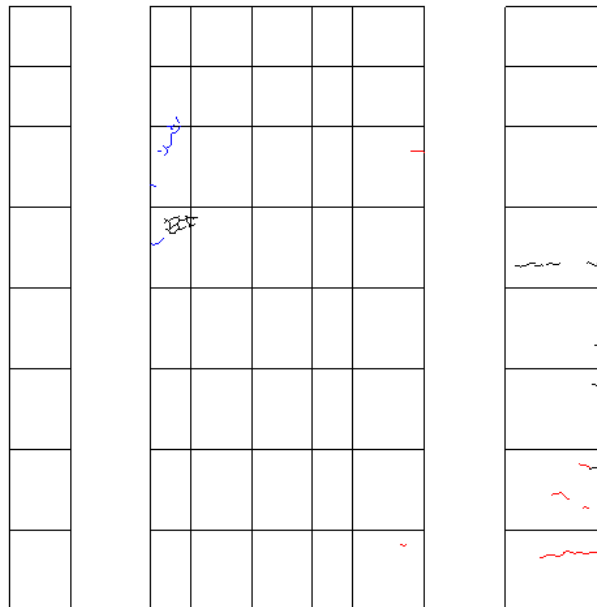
R=-1/1600 ひび割れ図
